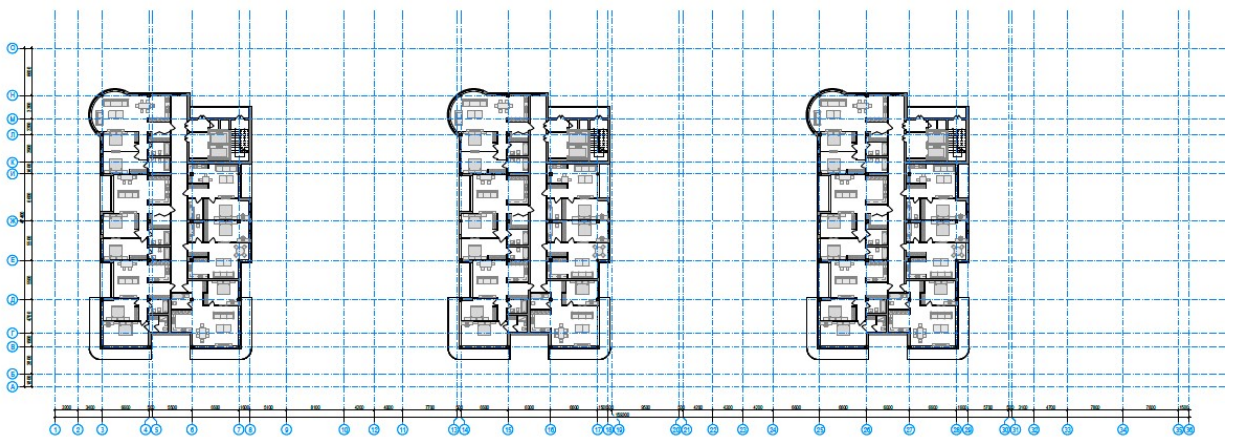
План другого поверху М1:200 на відмітці +3,400
